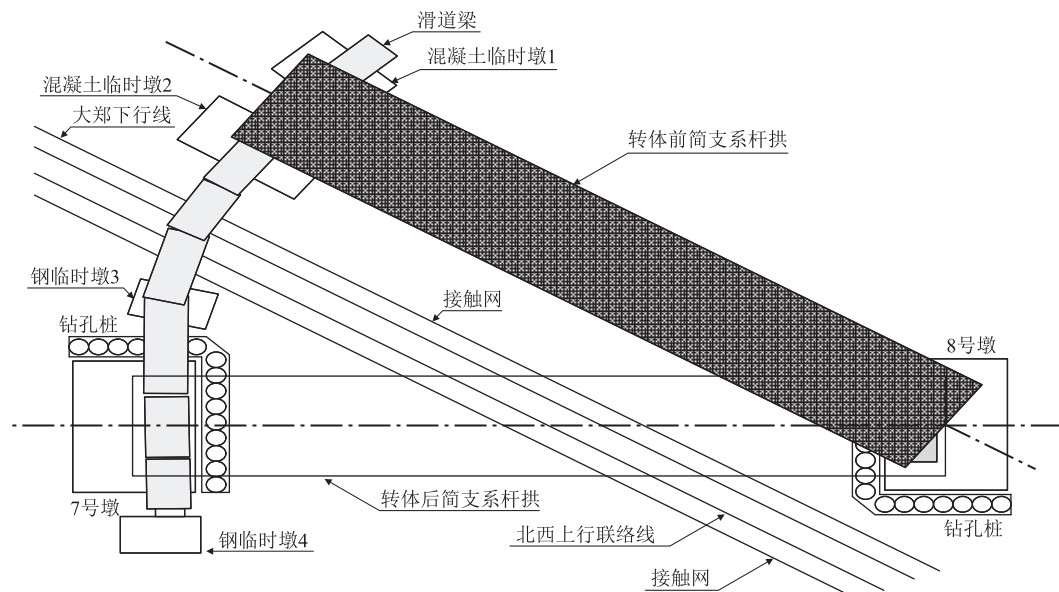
改京通右线大桥 7 号、8 号墩孔跨(1-64) m 简支系杆拱施工现场平面布置示意图
